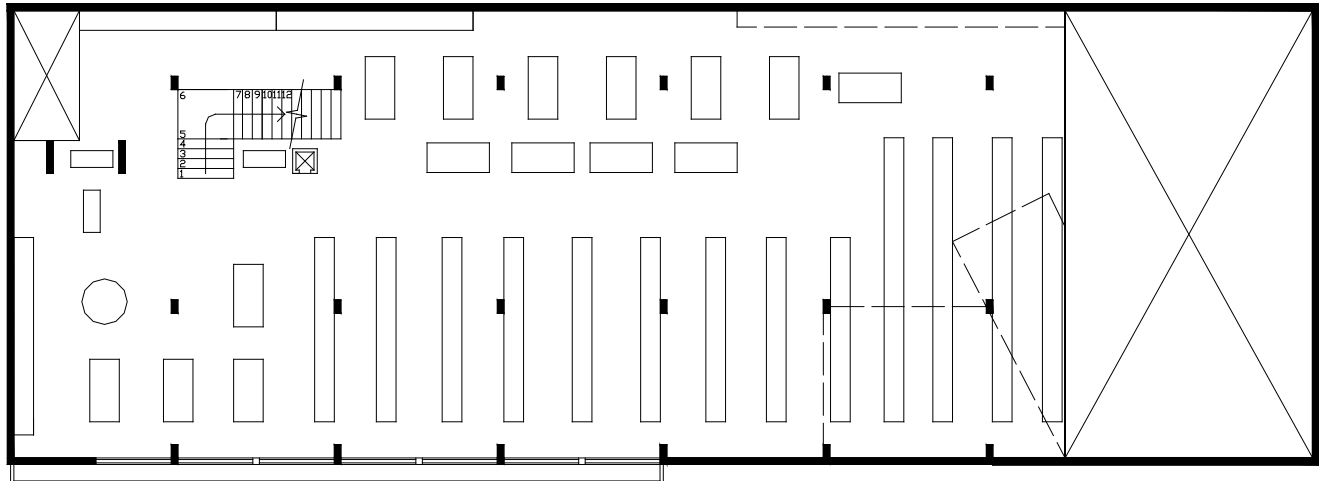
Layout da planta-baixa do subsolo da Biblioteca Municipal de Maringá com mobiliário.
